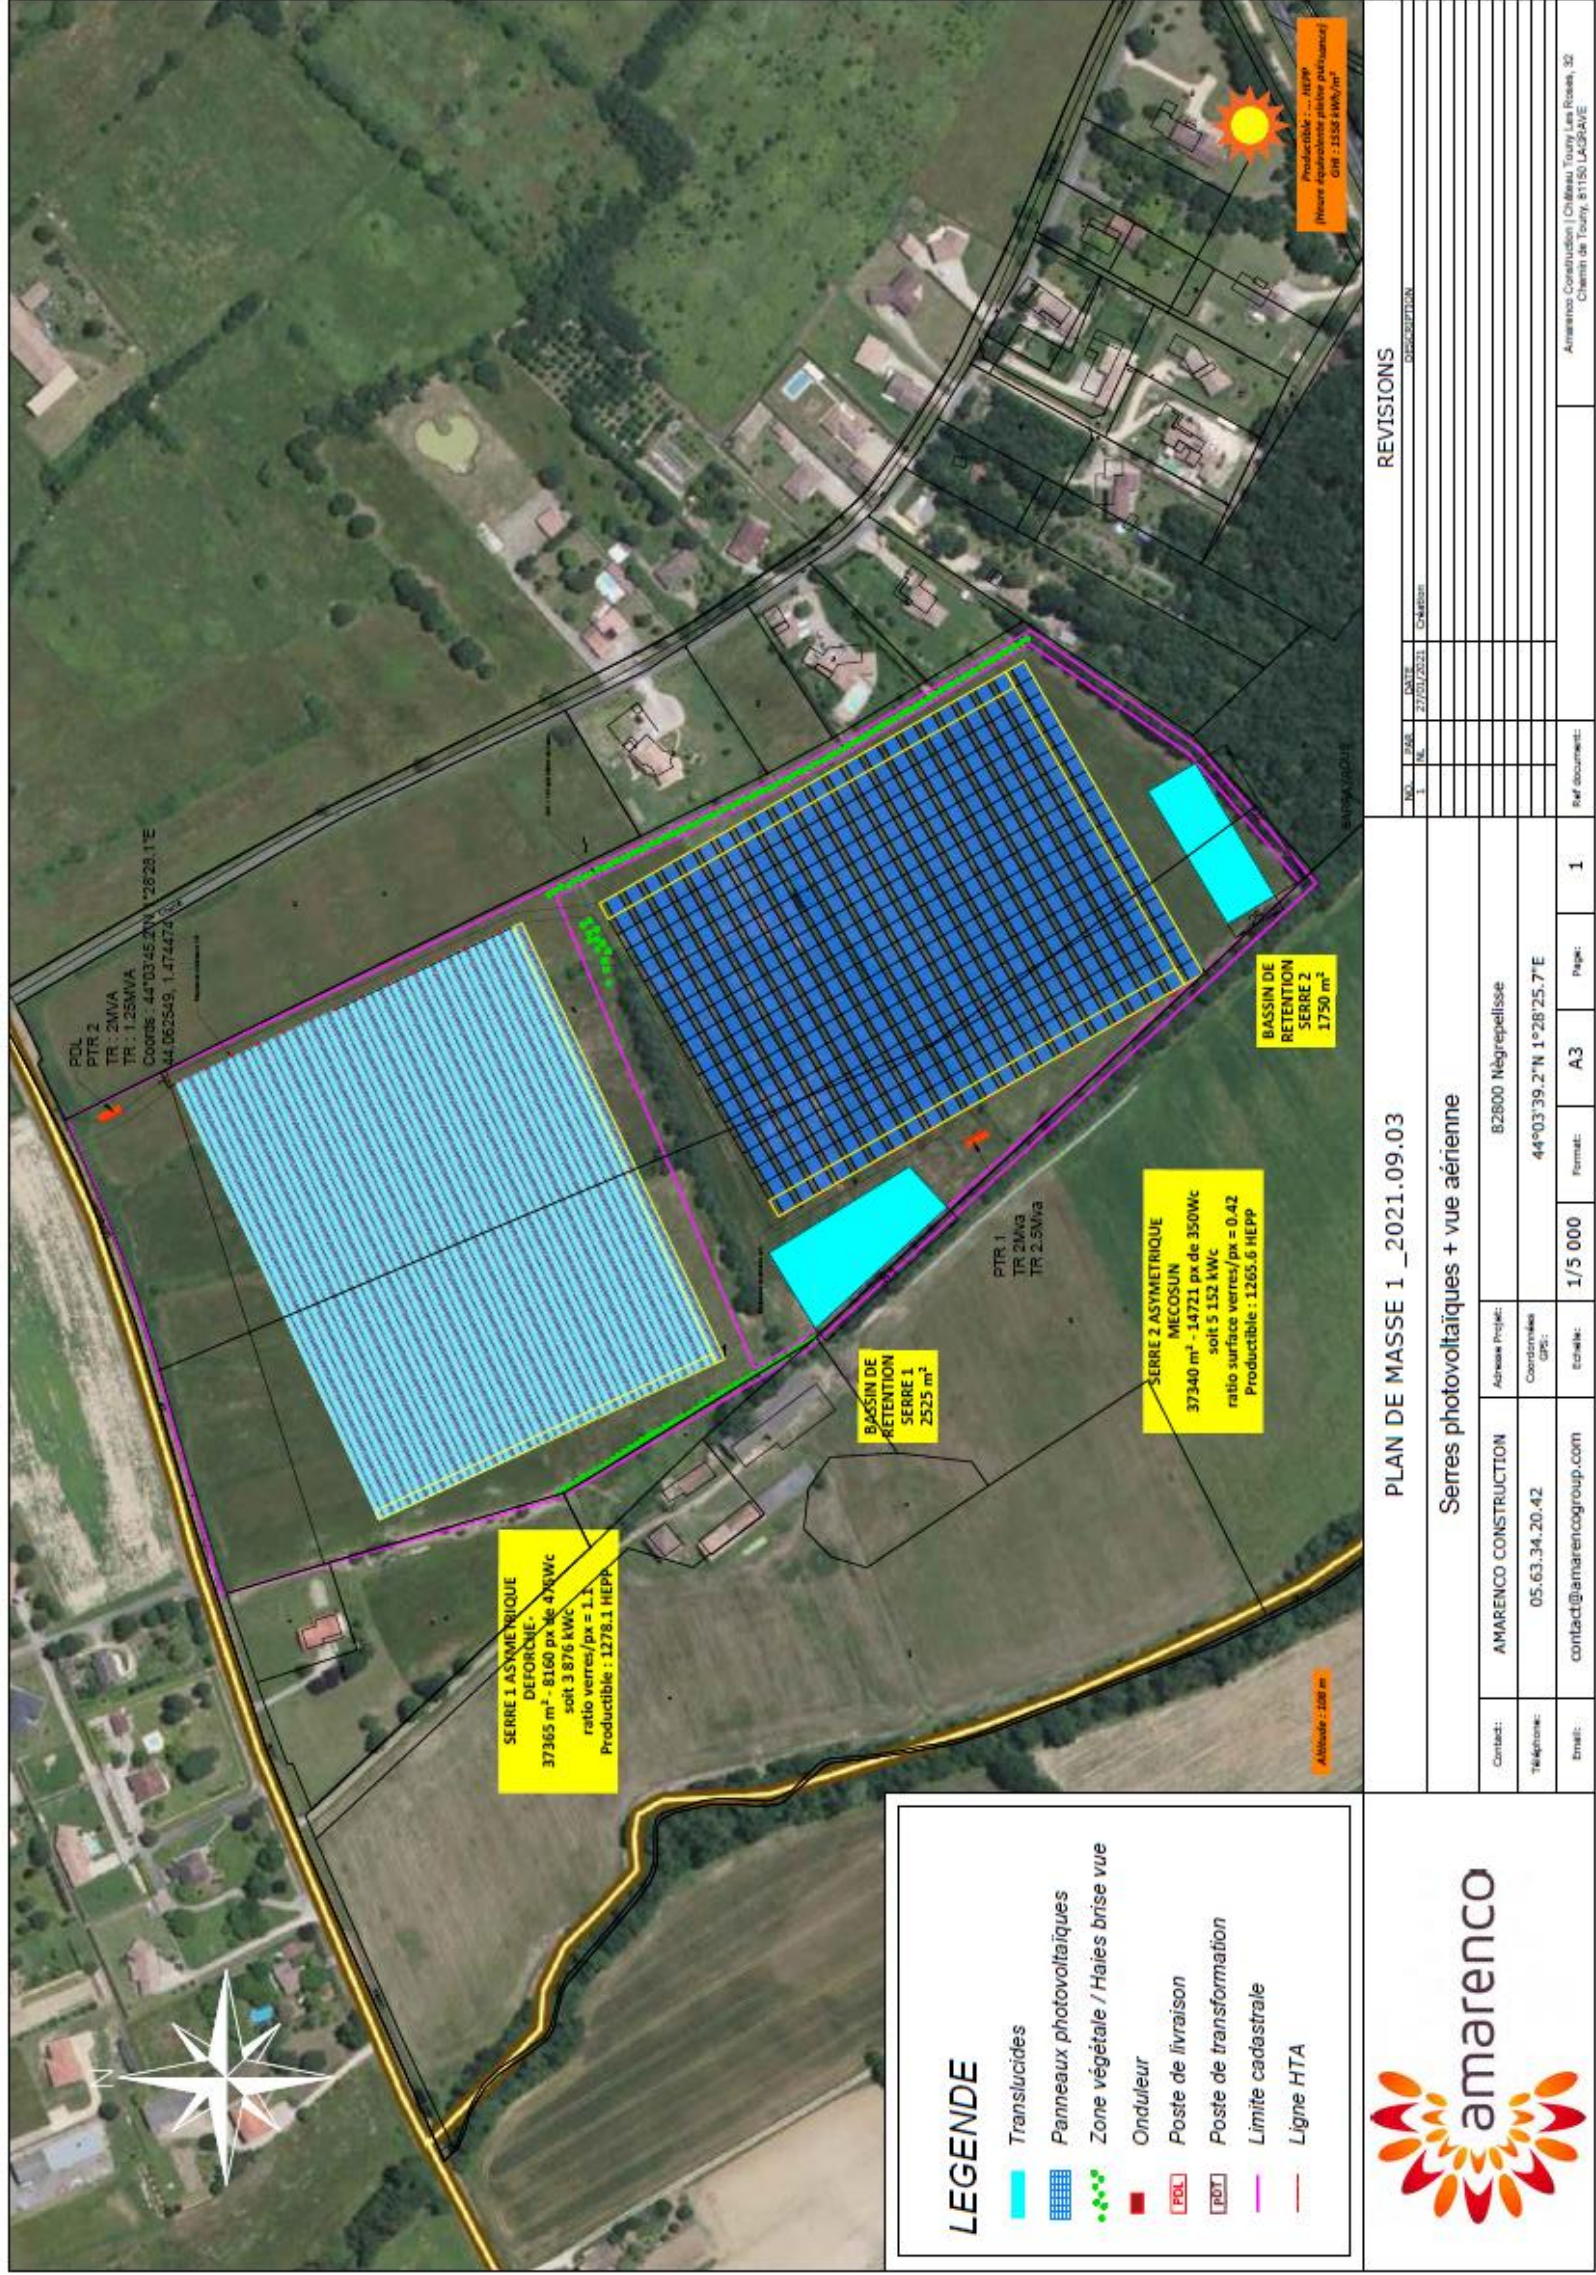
Plan d'implantation de la variante 2 – Source : Amarenco
